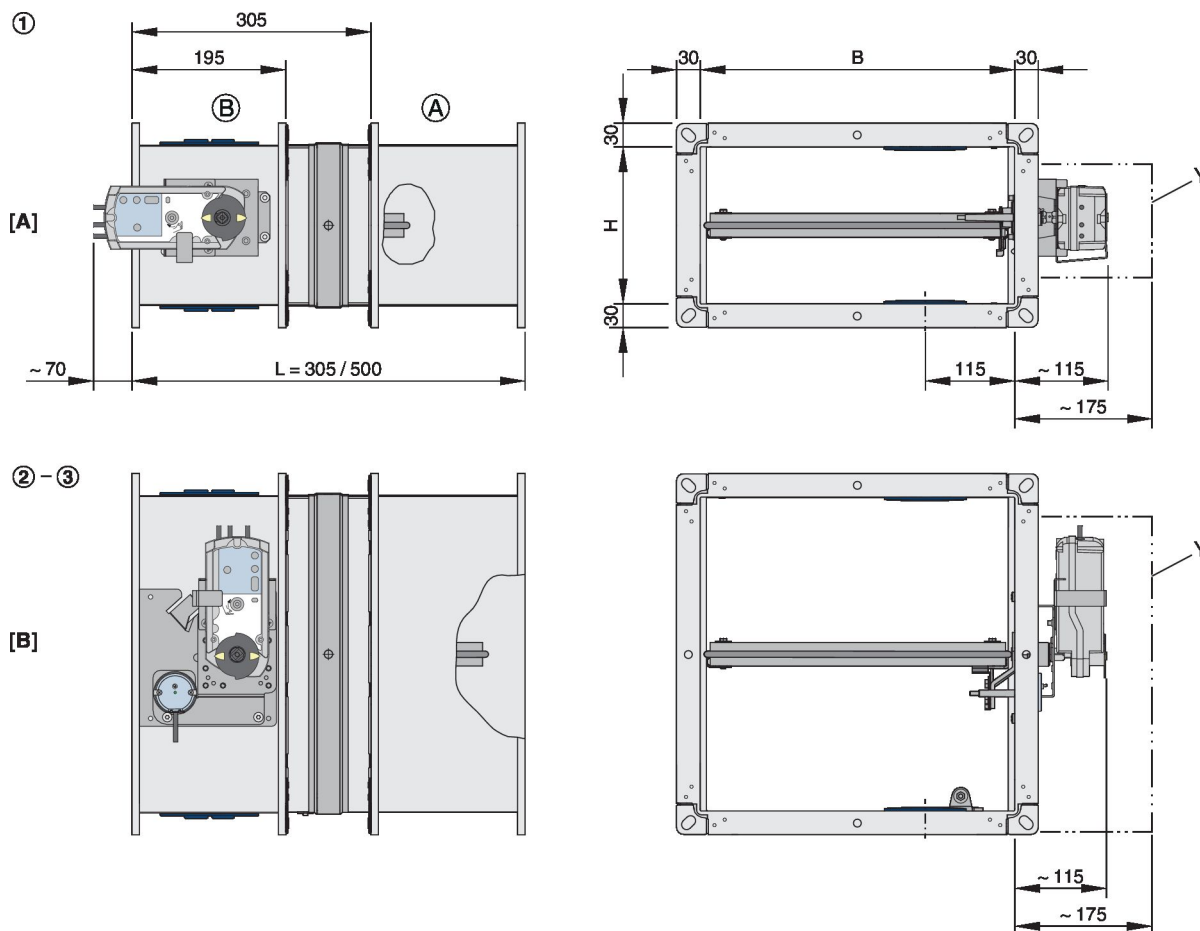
FKA2-EU med Siemens fjærreturaktuator
